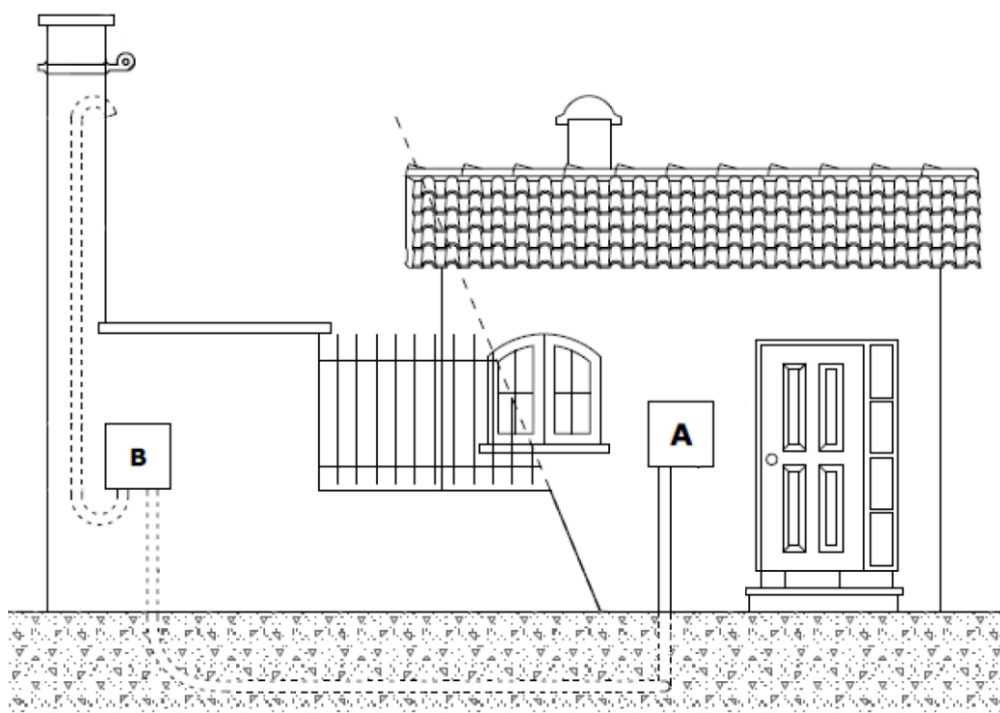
Exemplo de uma ligação aérea de uma instalação dotada de muro com pilar (E-Redes, 2021a).
